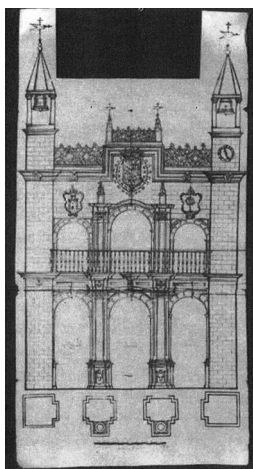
Varagaña. Fachada Ayuntamiento. Proyecto de nueva fachada.
